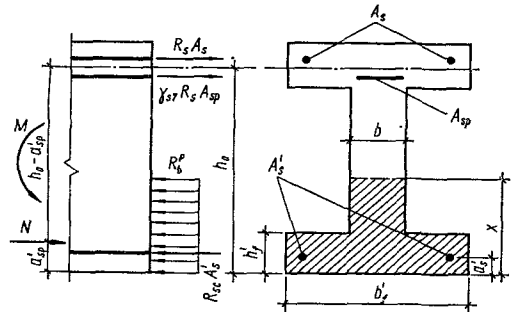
Схема усилий в поперечном сечении внецентренно-обжатого железобетонного элемента с полкой в сжатой зоне:
